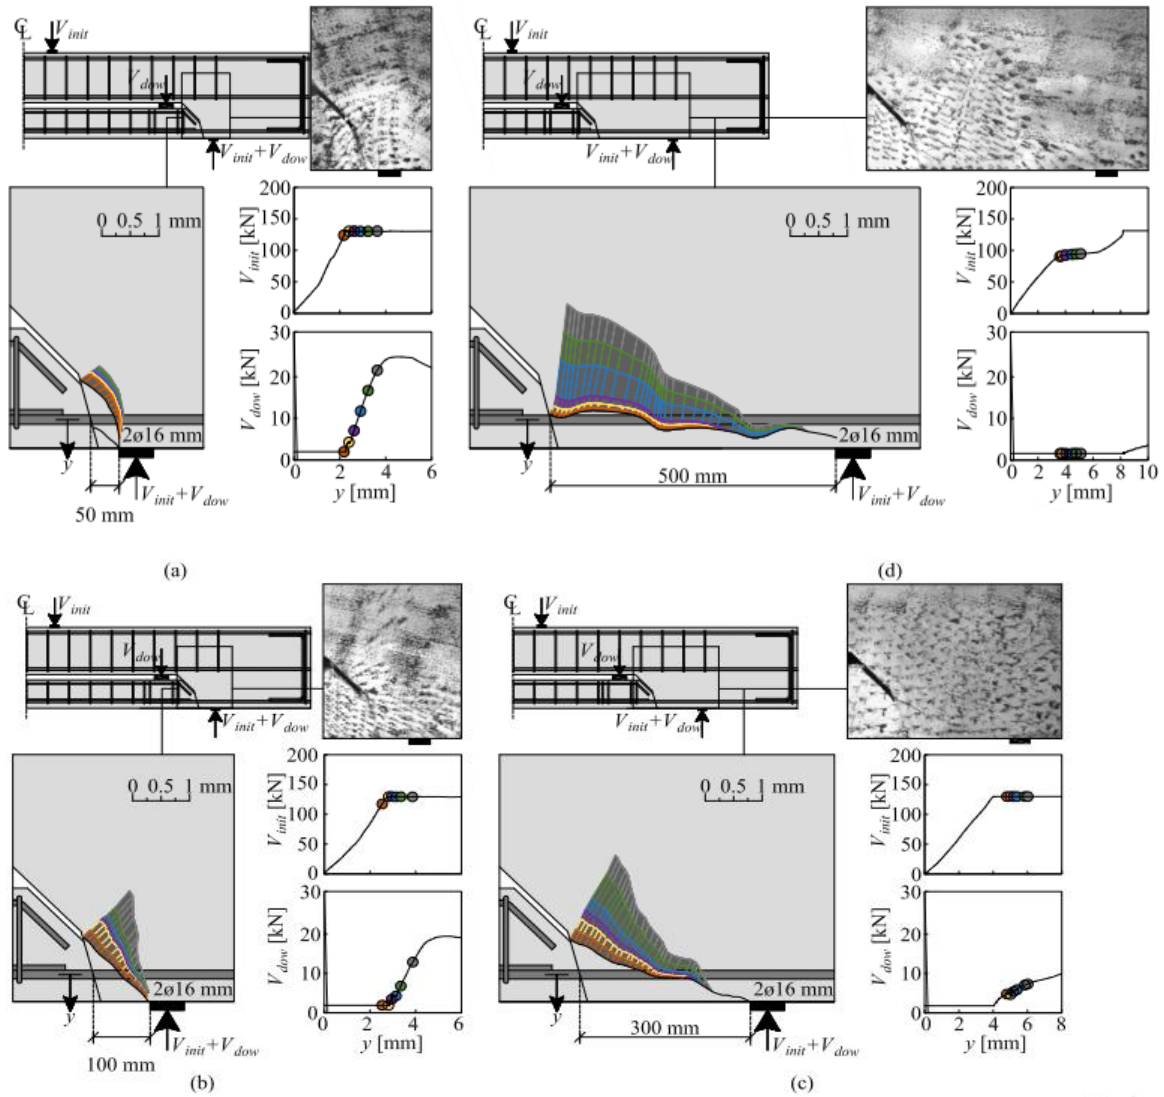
Cinématique de fissuration mesurée et réponse force de goujon-déplacement de goujon pour (a) l'éprouvette B.16.05.80.A, (b) l'éprouvette B.16.10.80.A, (c) l'éprouvette B.16.30.80.B et (d) l'éprouvette B.16.50.80.A [7].
